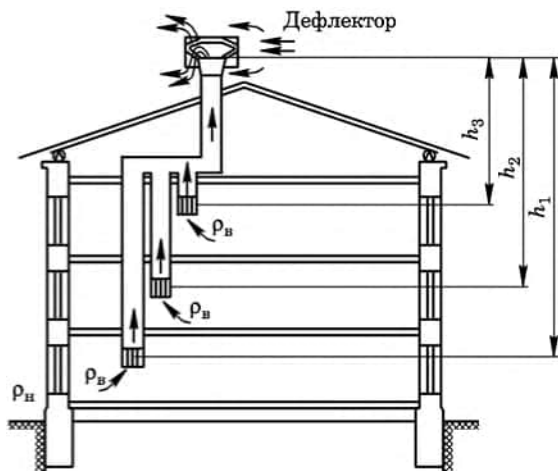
Схема вытяжной естественной вентиляции зданий
